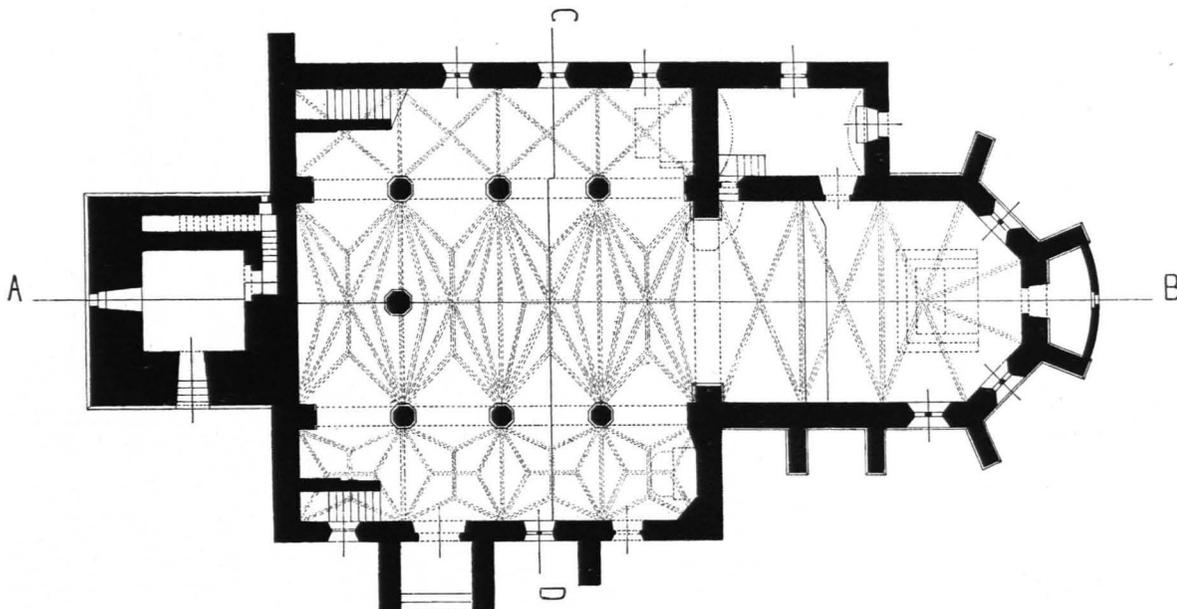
a Döllersheim, Pfarrkirche, Grundriß (S. 21)
